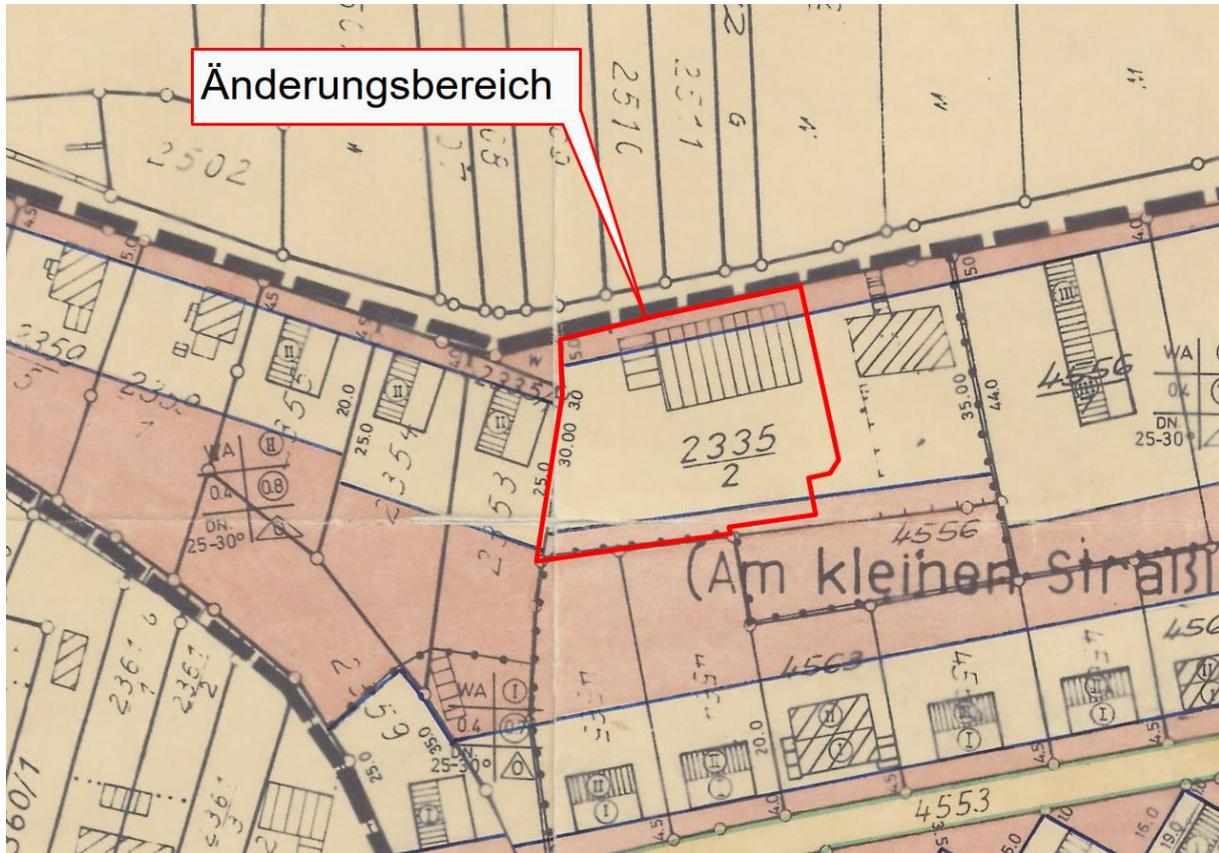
Bebauungsplan „Stiegele“, rechtsverbindlich seit dem 23.11.1977
